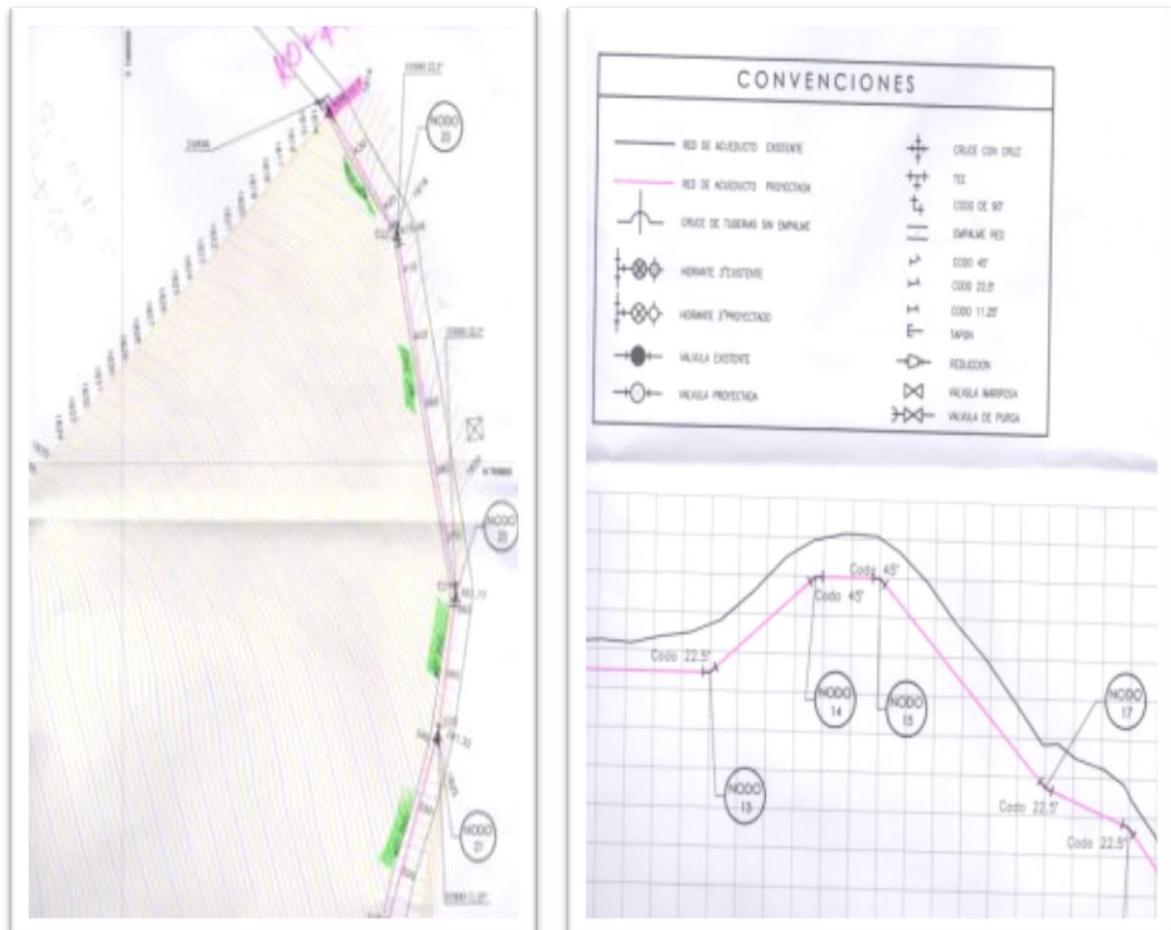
Planos en planta y en perfil, Proyecto “Subramal Vía Totoró Margen izquierdo”.
